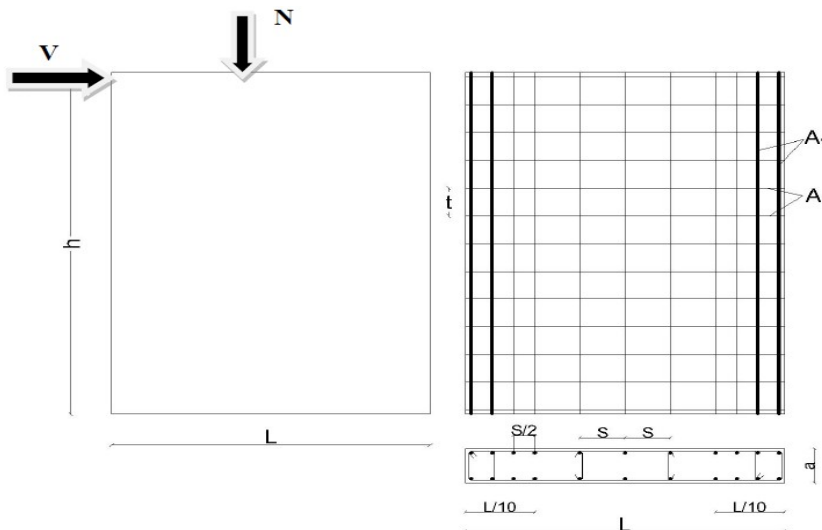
Schéma d'un voile plein et disposition du ferrailage.
